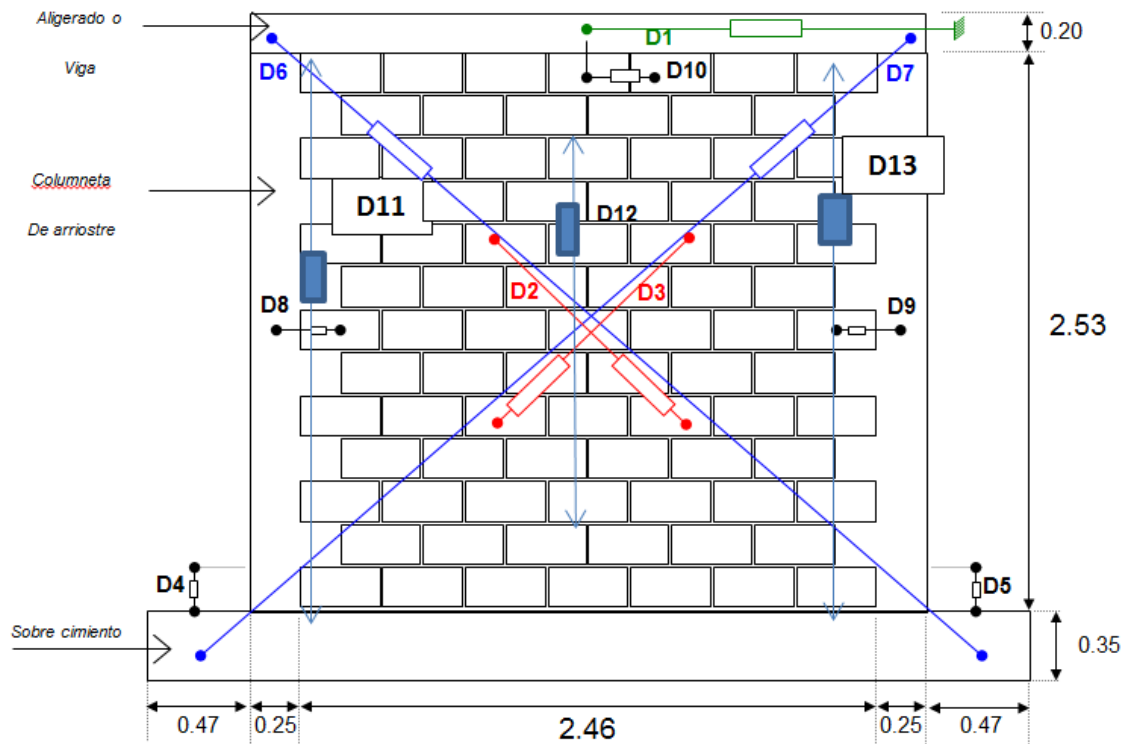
Plano de instrumentación de Muro con carga vertical
